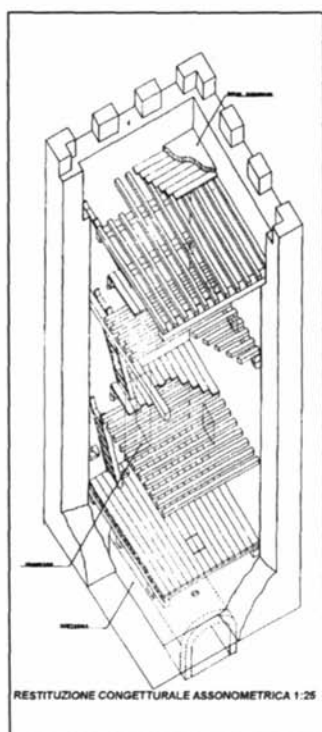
Castel Pedreso: restituzione congetturale dei ripiani interni del mastio. Riduzione dall'assonometria originale eseguita dall'autore e dalla geom. Daniela Manca.
